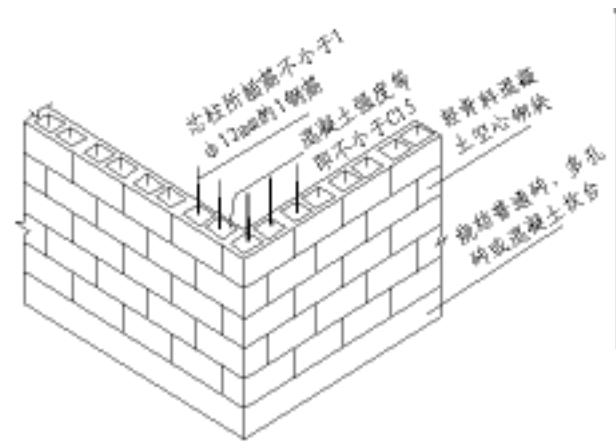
轻骨料混凝土空心砌块转角砌法
